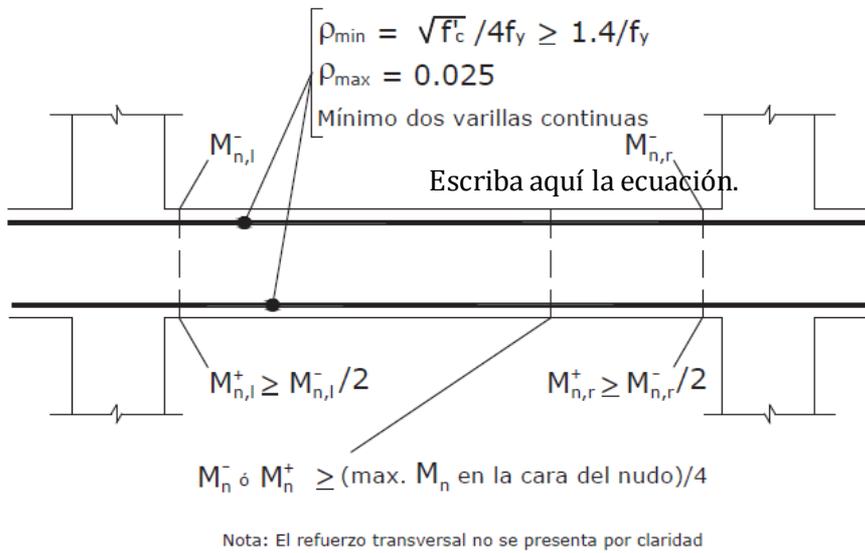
Requisitos del refuerzo longitudinal en elementos a flexión
